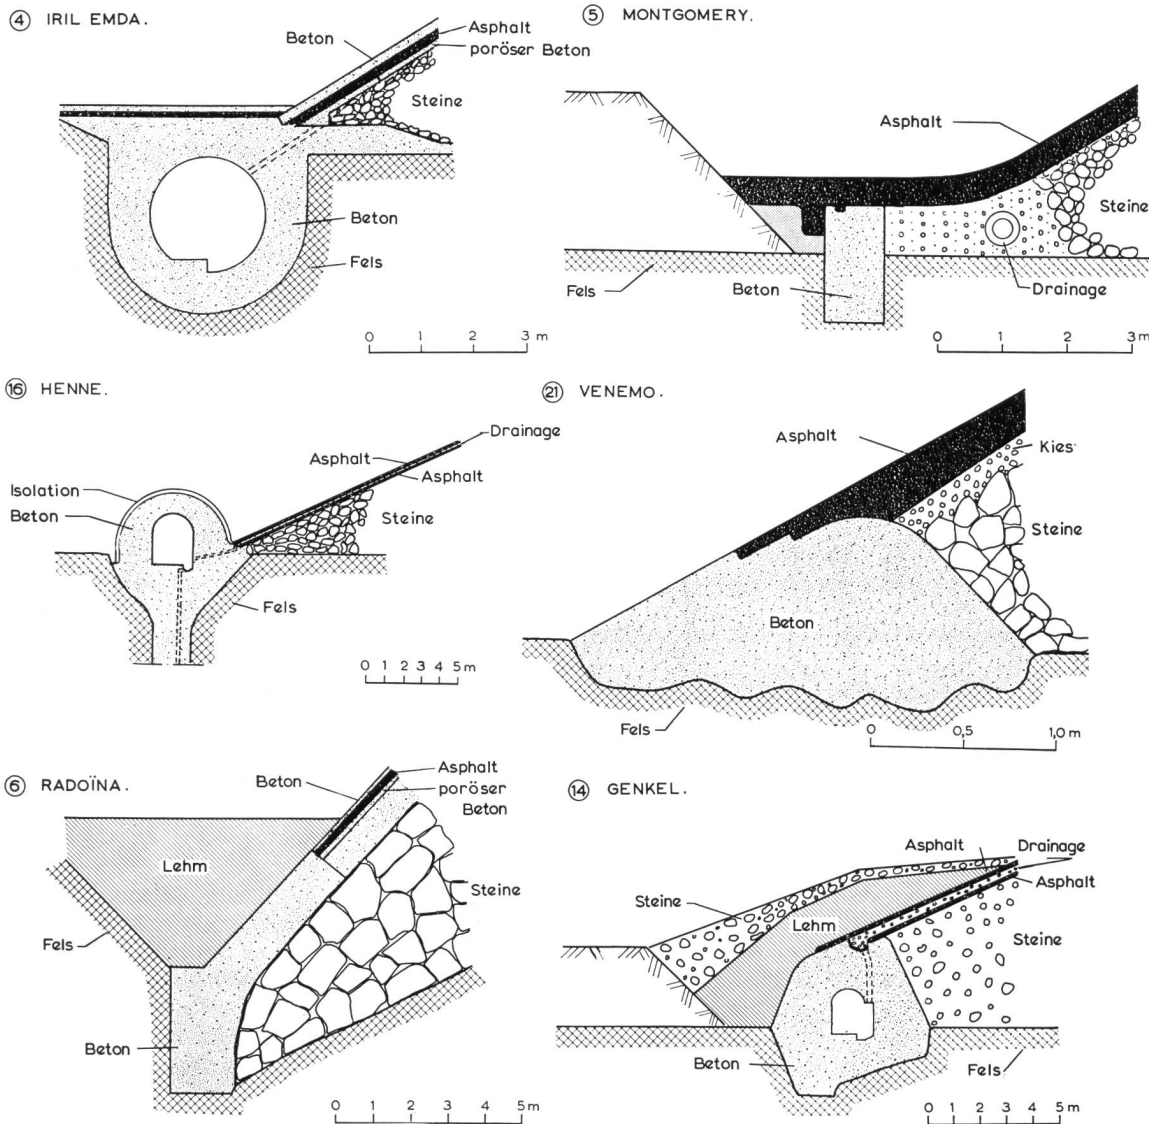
Sechs Konstruktionsbeispiele des Fundamentsockels am oberwasserseitigen Dammfuss
